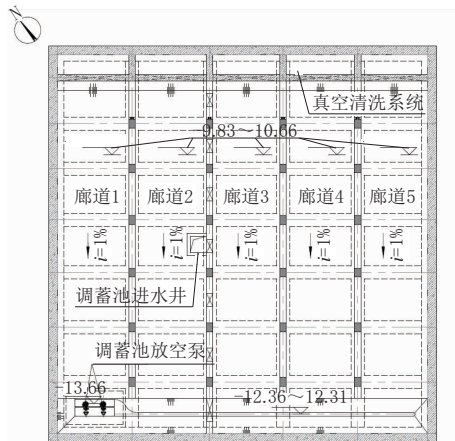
泵房及调蓄池地下 2 层平面图(单位:m)
